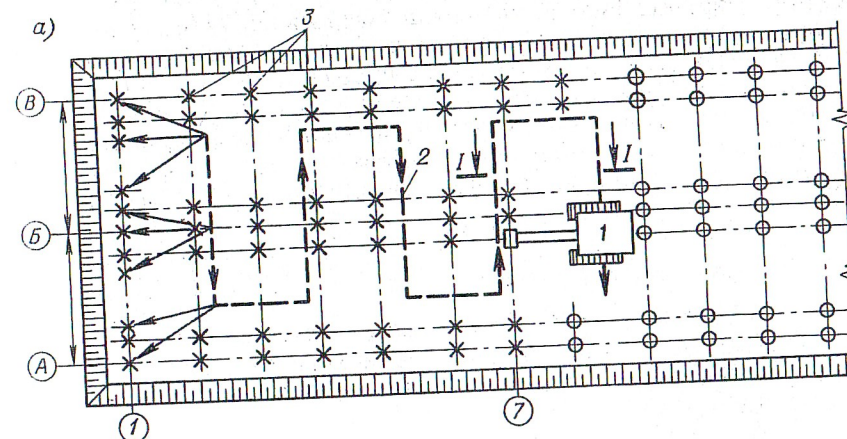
Схема забивки свай сваебойным агрегатом на базе крана-экскаватора
